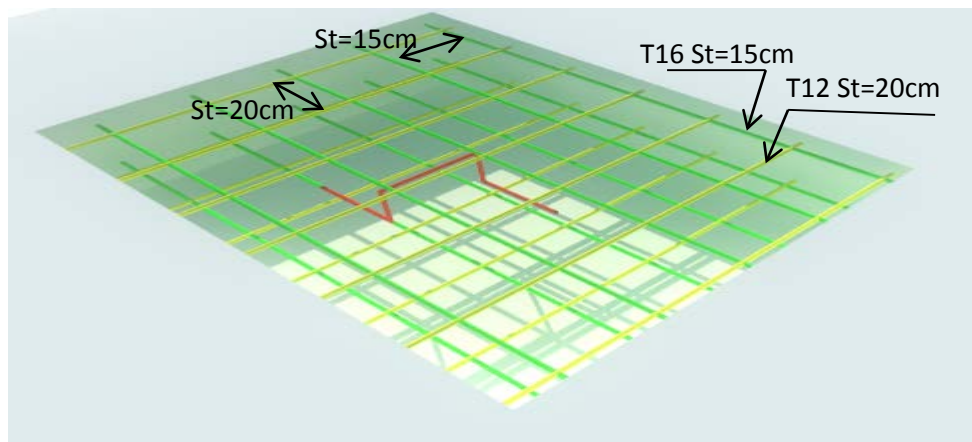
Ferrailage de la dalle salle machine en 3D.
